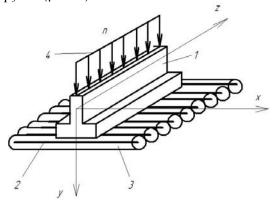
Реальная схема закрепления основания ленточного фундамента ГИК: I — ленточный фундамент; 2 — геоимплантат; 3 — зона уплотнения грунта вокруг ГИ; 4 — распределенная нагрузка на фундамент
